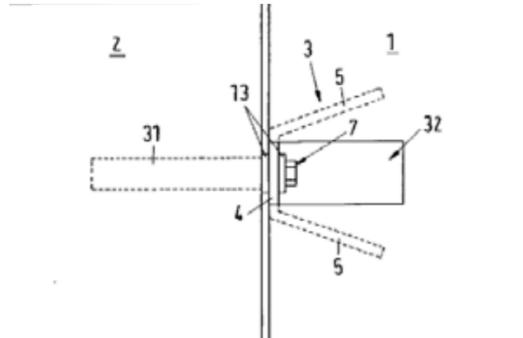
Conector prefabricado y sistema de conexión para conectar elementos de hormigón prefabricado (Patentscope, 2020).
